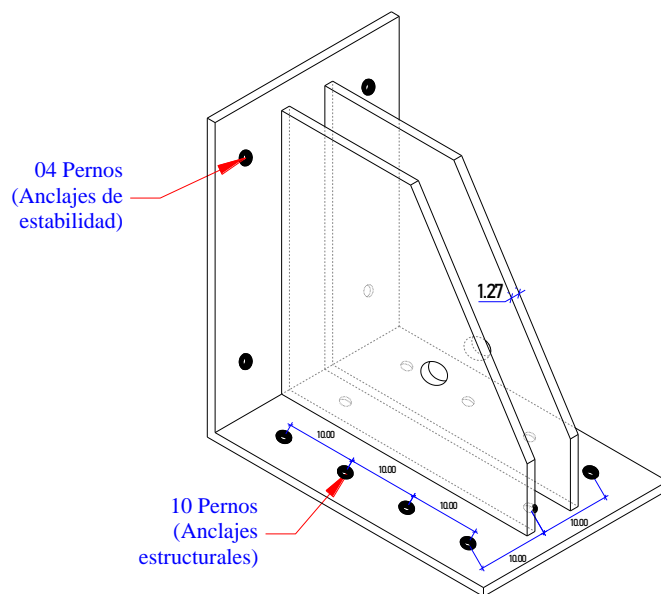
Plancha metálica sobre la cual irán los pernos de anclaje (Vista isométrica)
